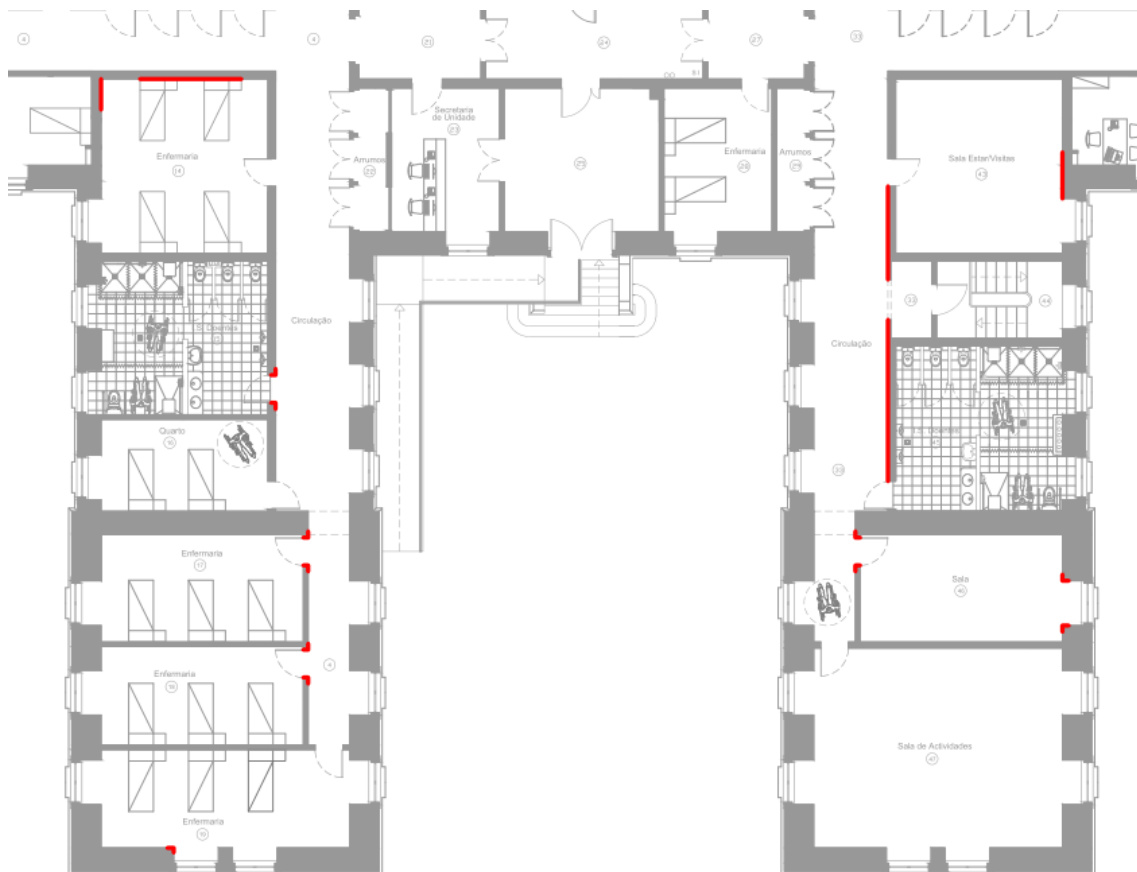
Planta da localização dos destacamentos e desgaste no piso 0 [FONTE: CHPL]
